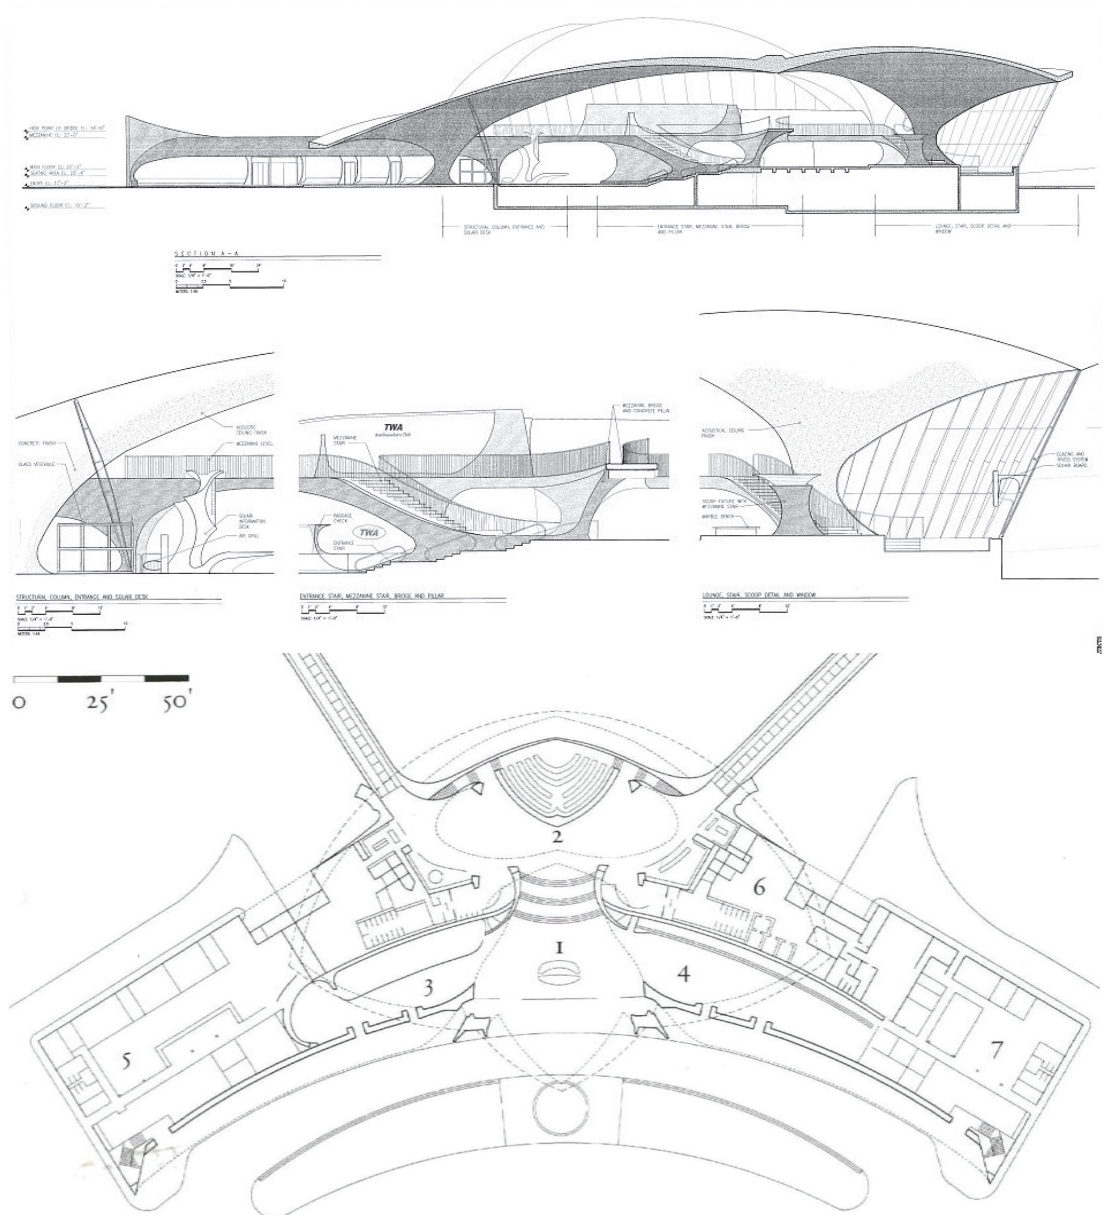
TWA Flight Centre - Grundrisse und Schnitte
